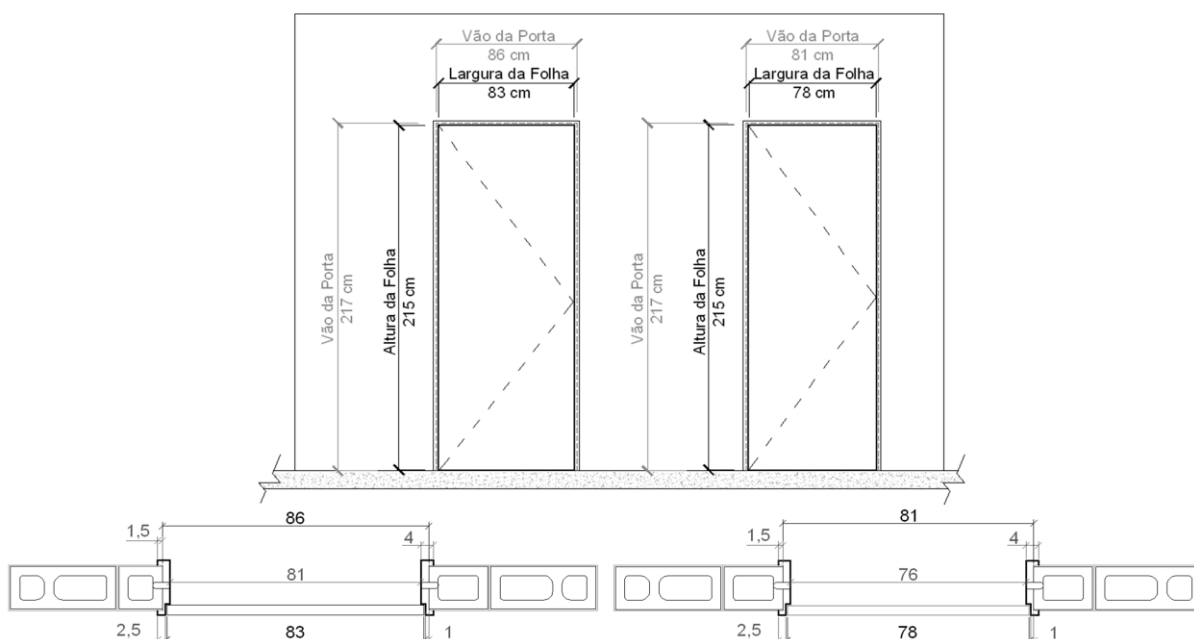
Batente metálico envolvente modular (medida em centímetros)
